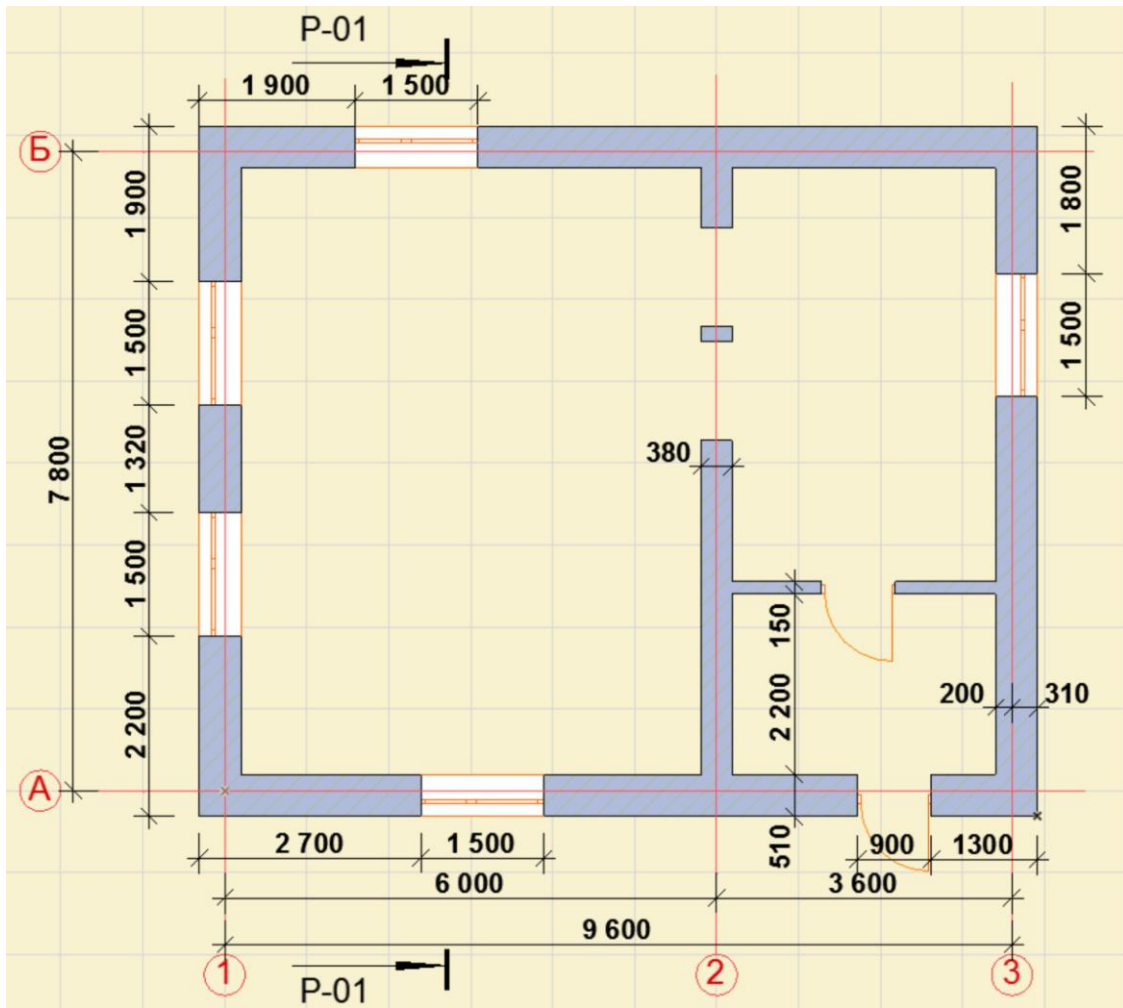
План первого этажа с осями, размерами и разрезом
